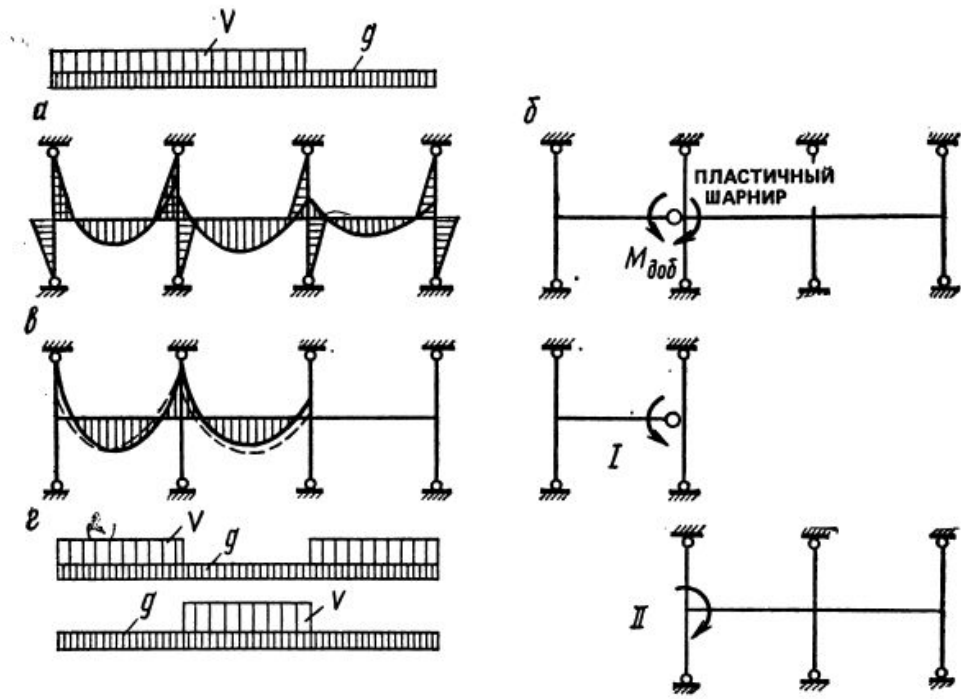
К расчету многоэтажных рам на вертикальные нагрузки по выравненным моментам
